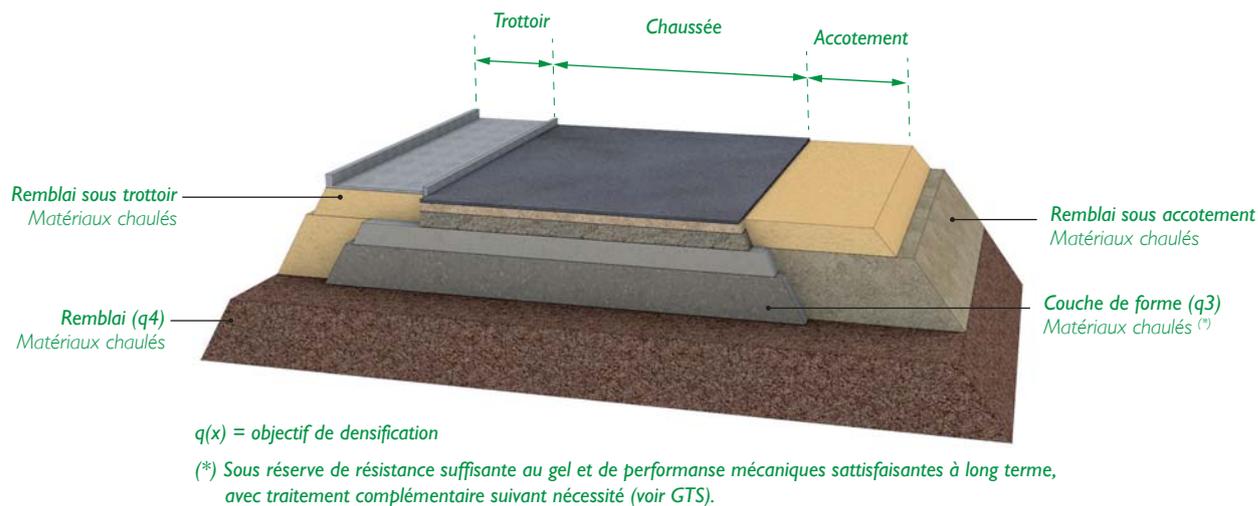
Usages possibles des matériaux chaulés au voisinage d'une structure de chaussée
